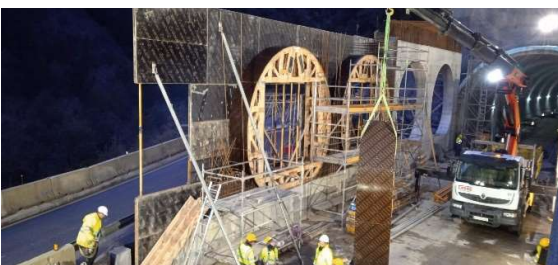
Ferrallado y encofrado de fase 2 de hastial derecho.
